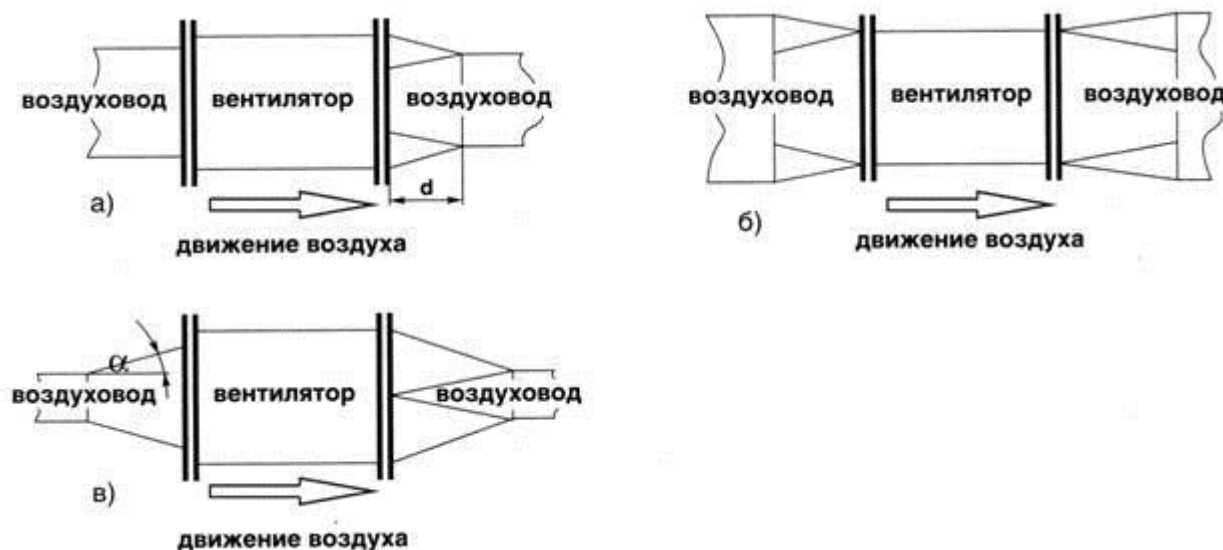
Соединения вентиляторов с круглыми воздуховодами
